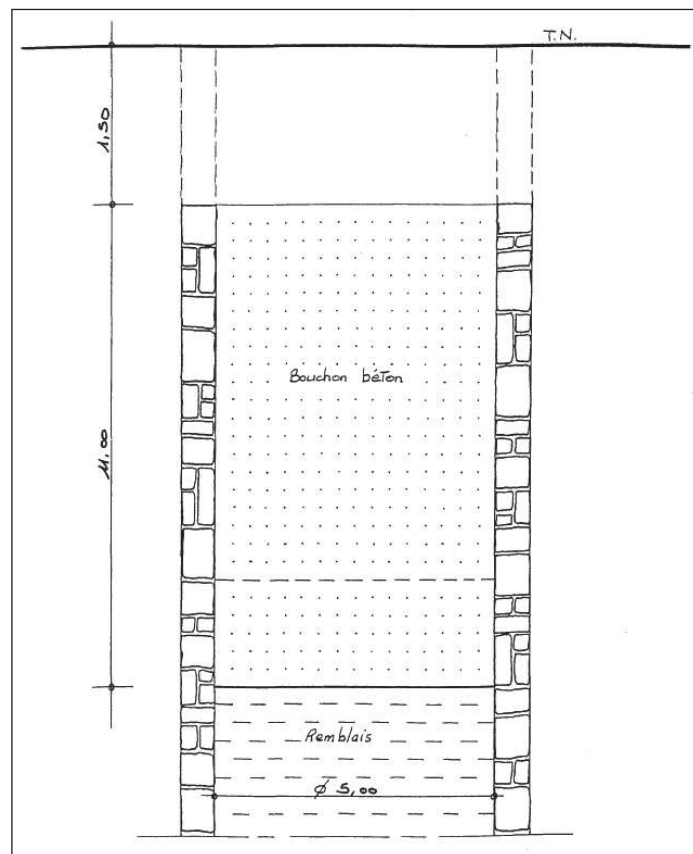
Schéma du bouchon béton mis en place au puits Bayard
